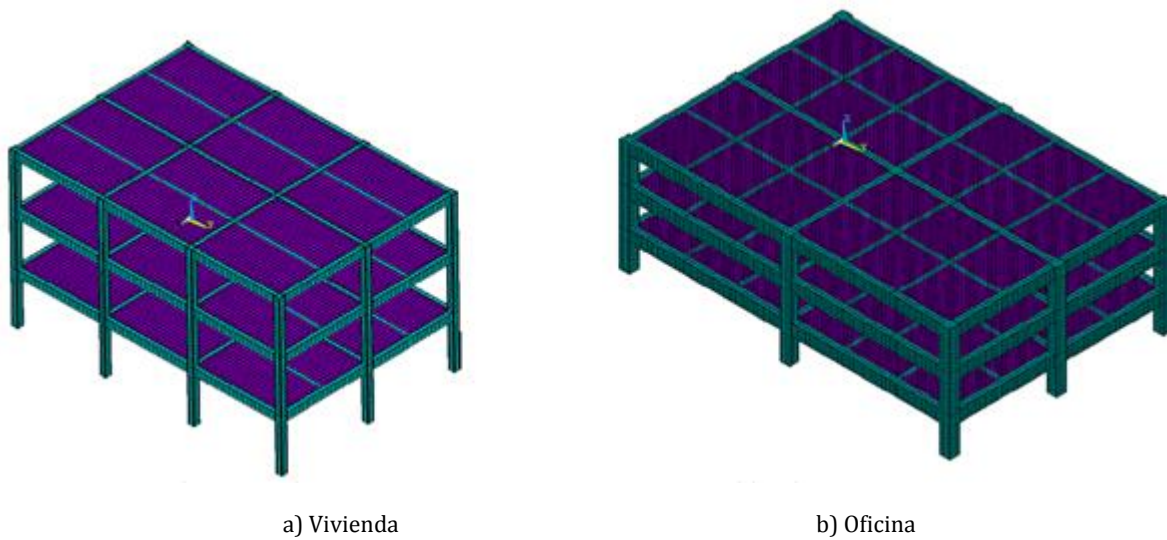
Estructuración de malla del modelo de losa perimetralmente apoyada
